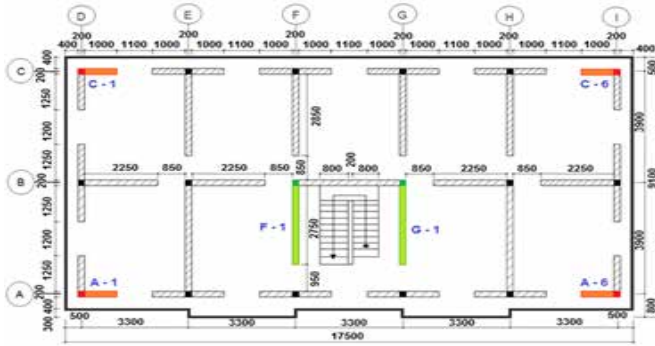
Planta arquitectónica y ubicación de los muros críticos
